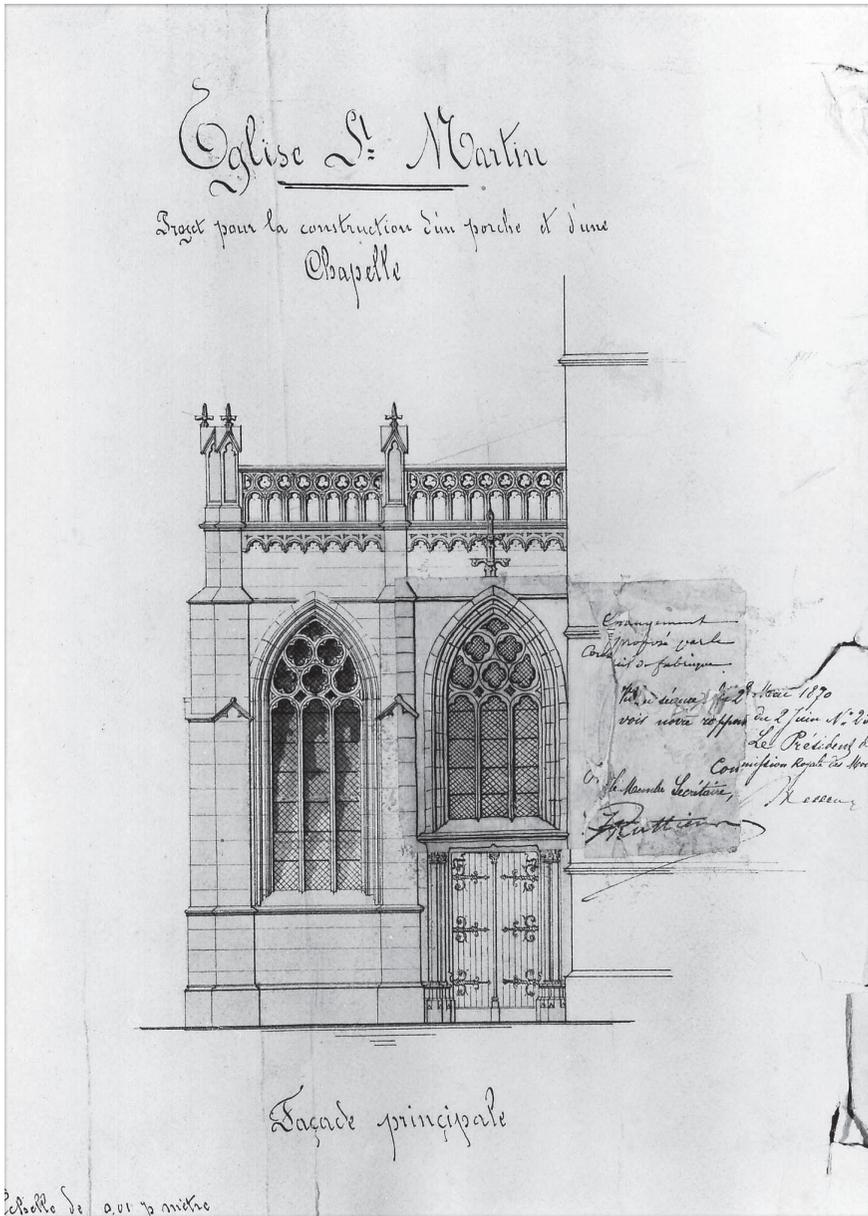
Projet de construction d'une chapelle et d'un portail pour le collatéral nord de la nef (élévation). Dessin d'Évariste Halkin, 10 avril 1868.
